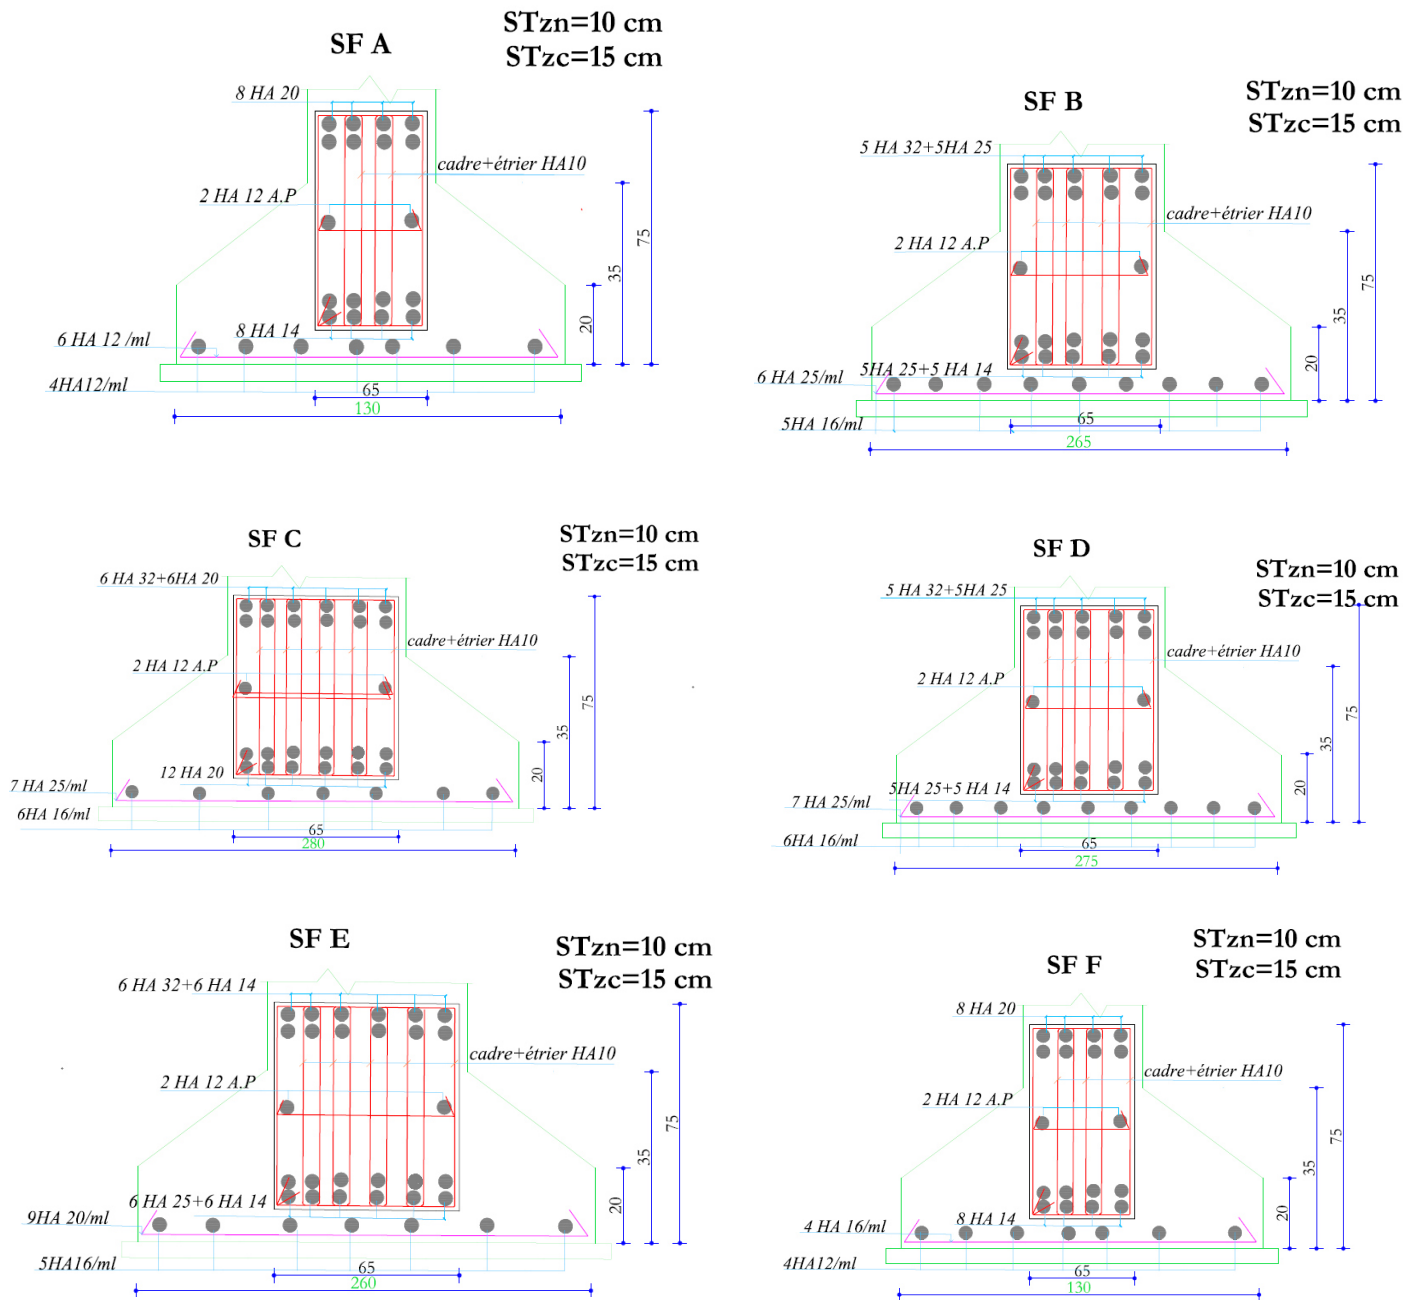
Schéma de ferrailage des différentes semelles filantes.
